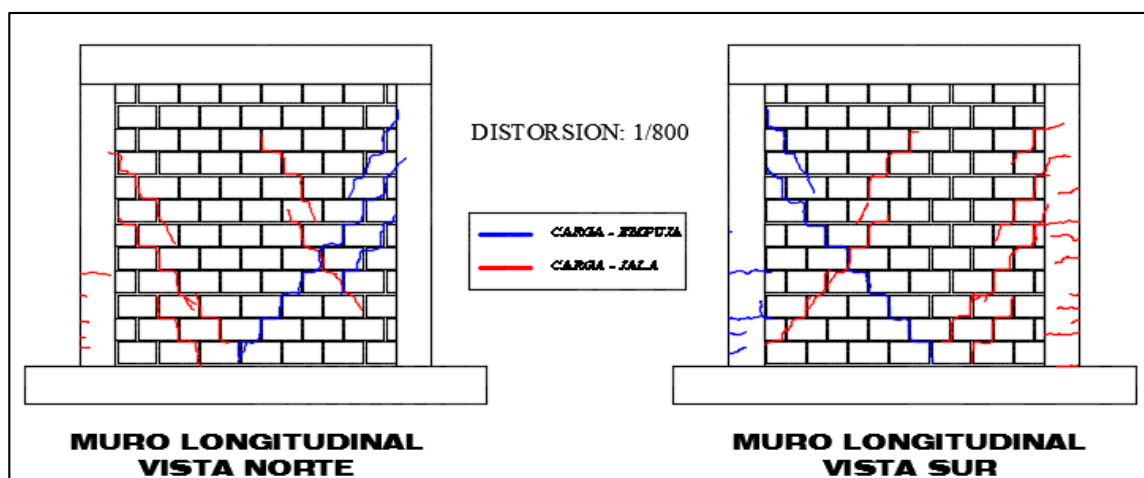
Mapeo de fisuras en muros para una distorsión de 1/800. Se puede observar que el muro empieza a agrietarse.
